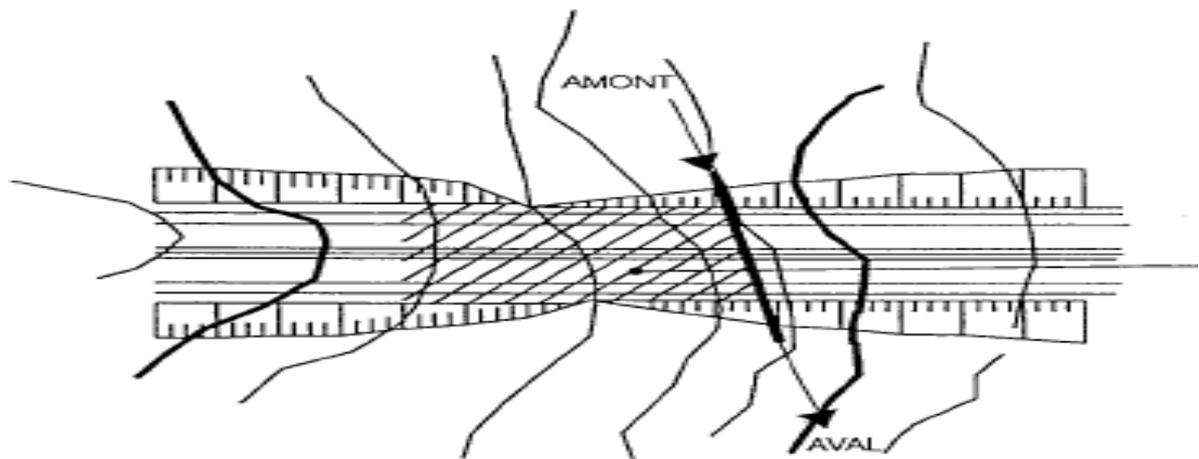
Schéma de drainage des eaux au niveau de la zone de transition déblai – remblai [1].
